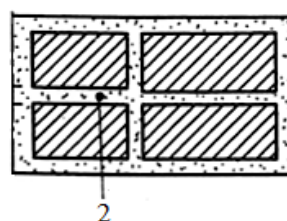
Пример армирования каменной стены с оконными и дверными проемами [12]
